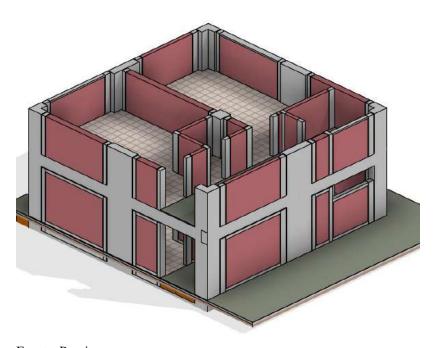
Modelo BIM, Vista en Planta del Primer Nivel de Área de Control.
